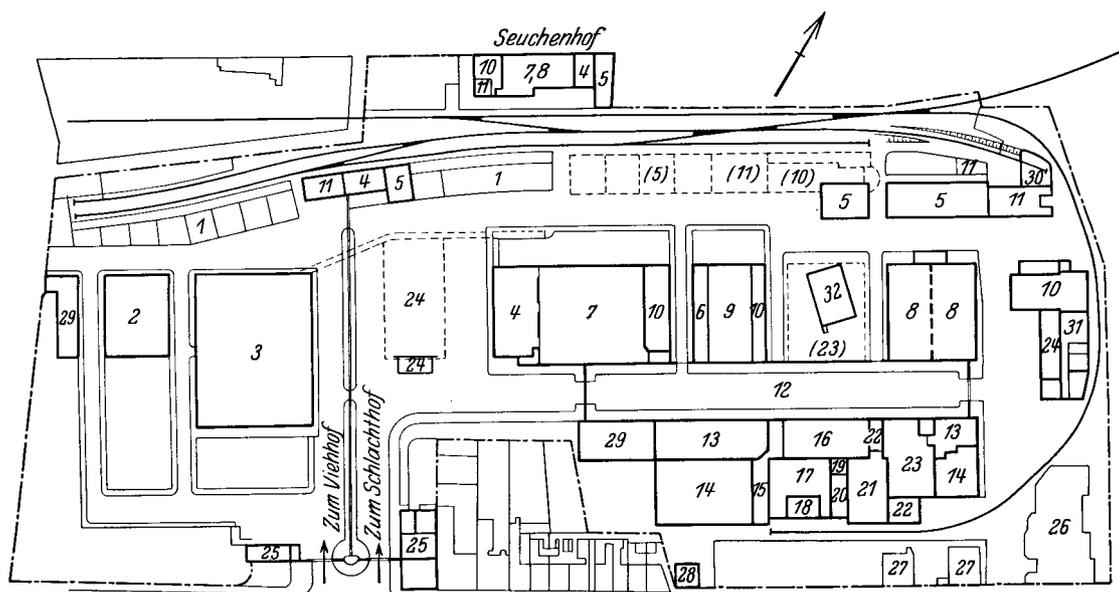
Lageplan der neuen Anlage (München-Gladbach).
